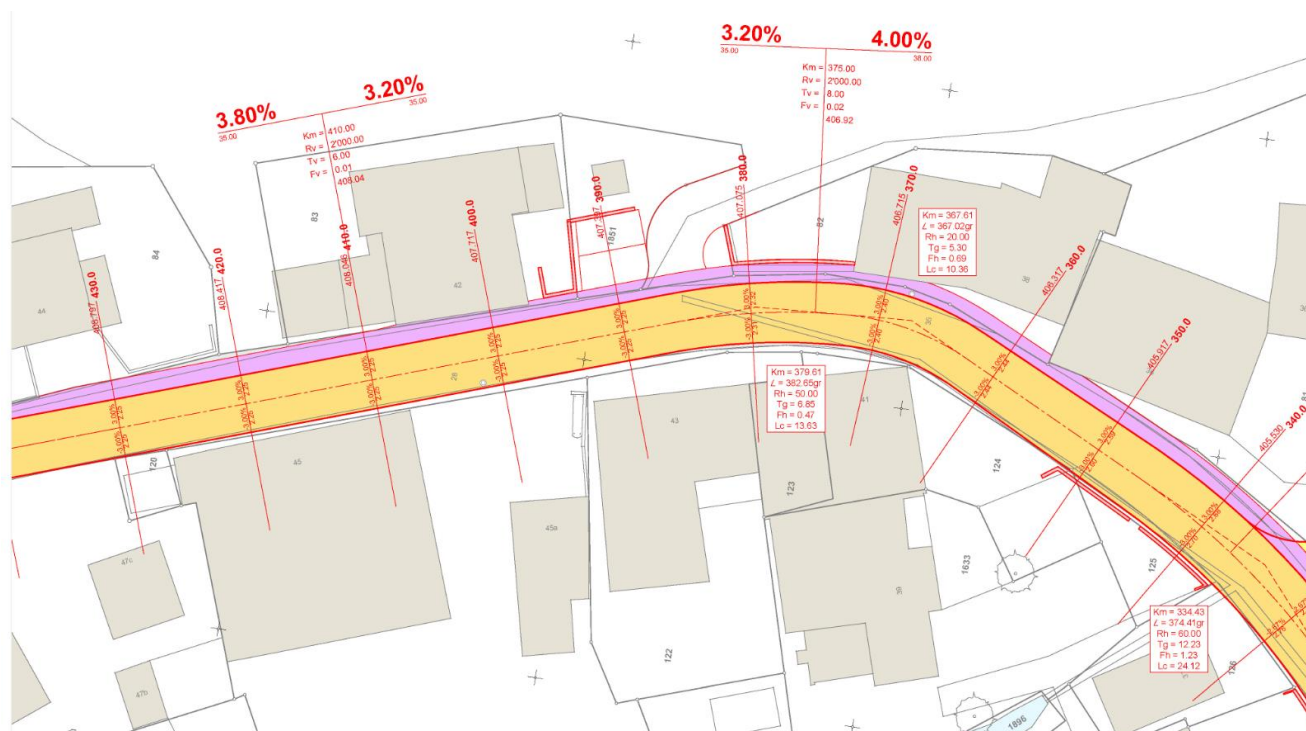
Strassenabschnitt mit einer Breite von 4.50 m und einer Trottoirbreite von 1.50 m (lokal schmaler und befahrbar)
